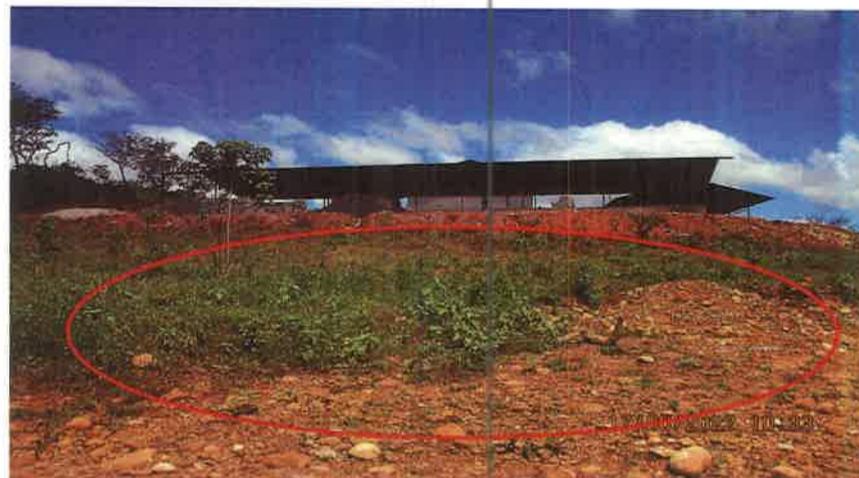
Área destinada para la construcción de las tinas de oxidación.
